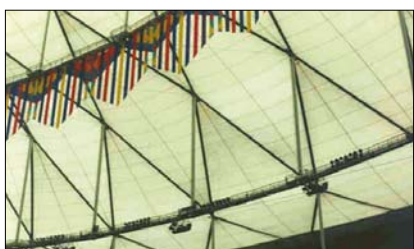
Dach membranowy nad stadionem w Stuttgarcie
